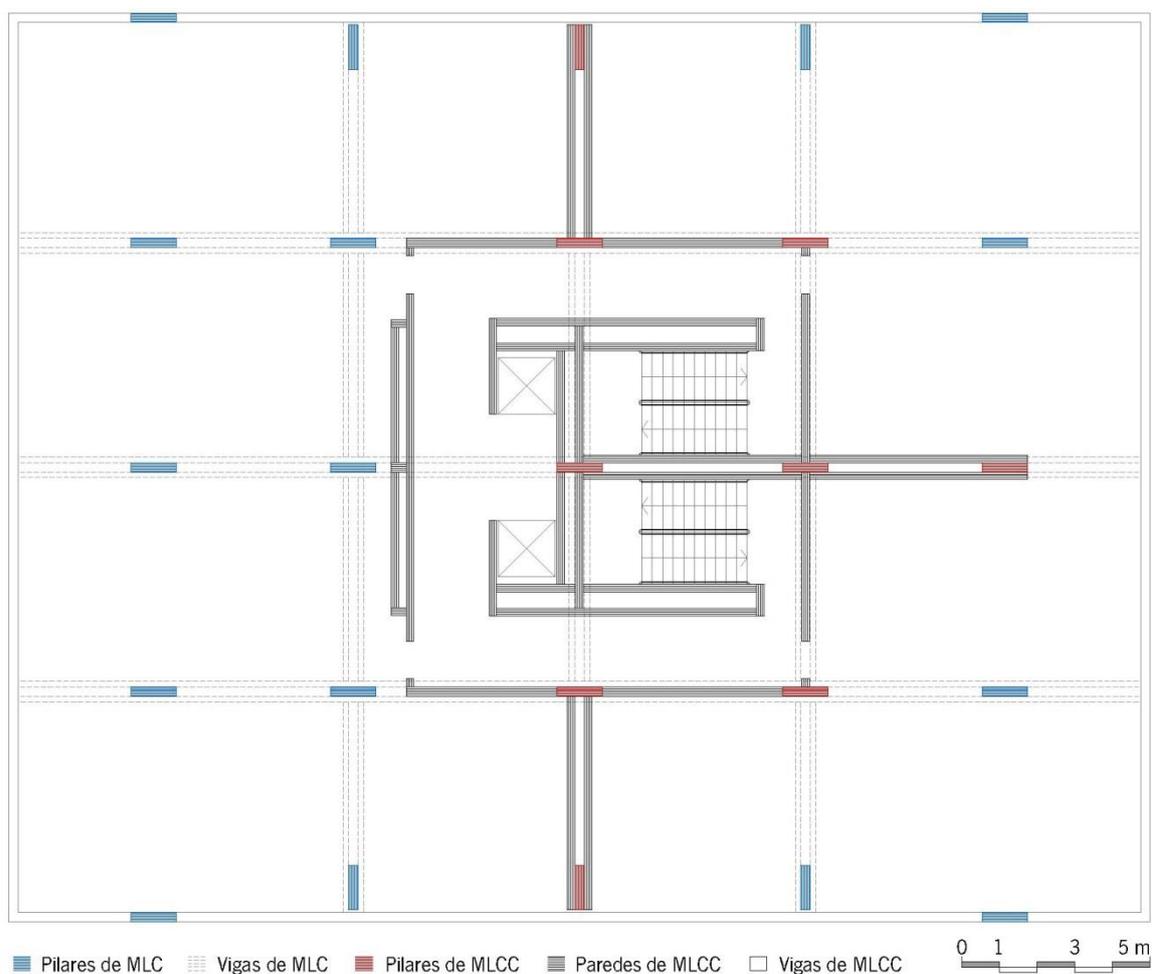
Planta de Piso-tipo com Elementos Estruturais do Tipo MLC 250 mm ³⁰
